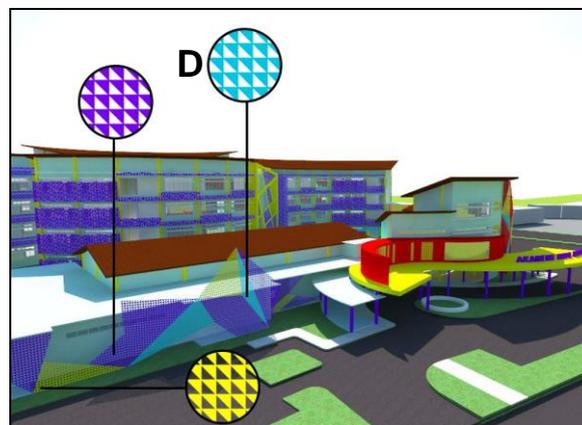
Detail tampak depan fasad dengan pola. Sumber: penulis
